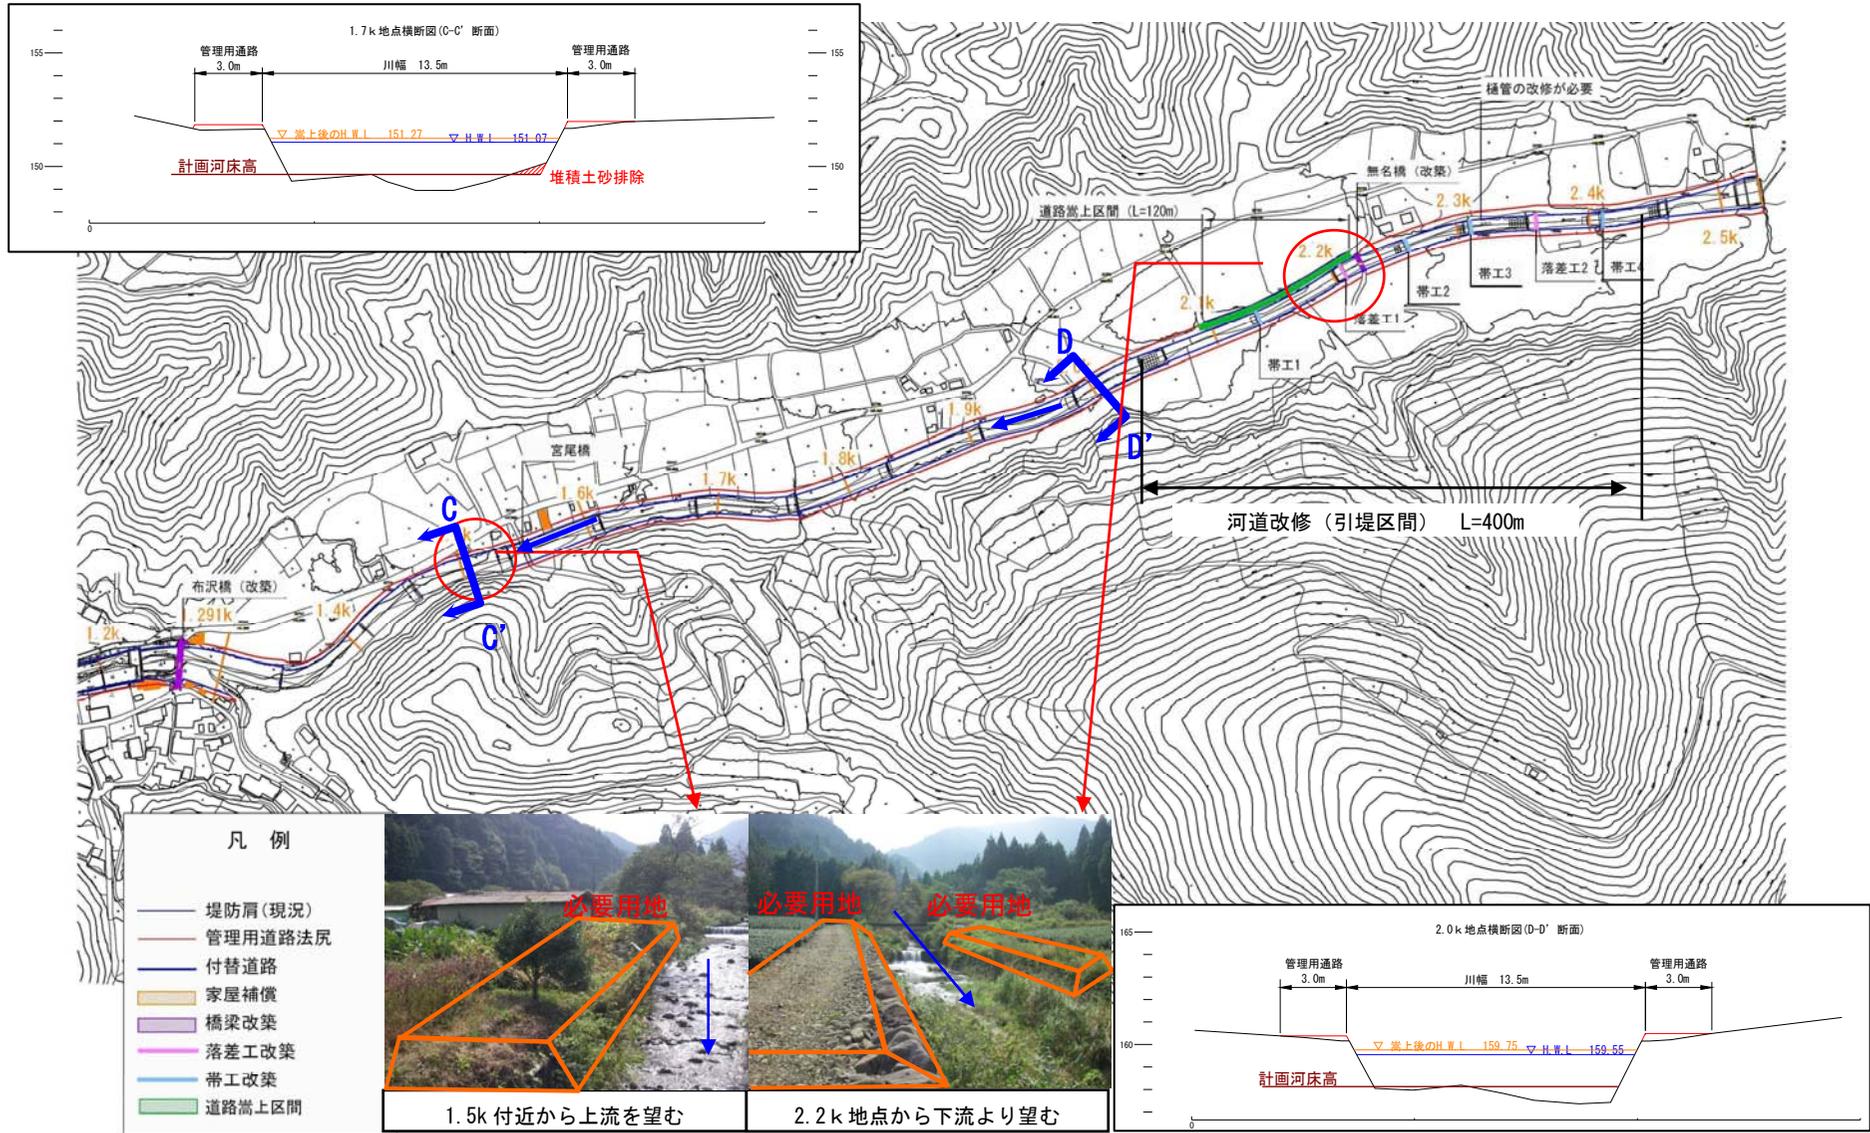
(2) 河道改修案の計画平面図(大沢川合流点~砂防堰堤)
